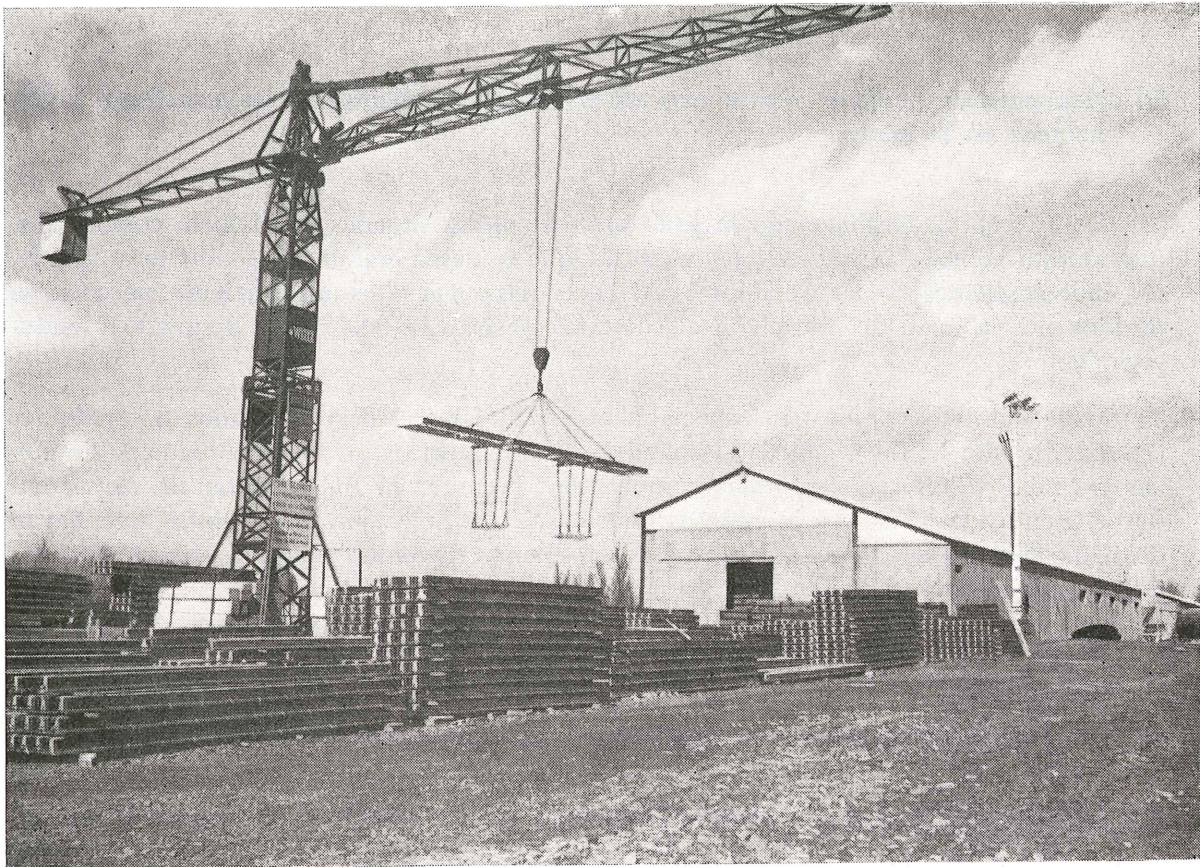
En la fábrica de Graçay, el endurecimiento de las viguetas pretensadas de cerámica y hormigón se acelera empleando las armaduras como resistencias eléctricas de calentamiento. A las veintidós horas, en ausencia del personal, un reloj regula automáticamente el calentamiento de la bancada fabricada durante el día.
